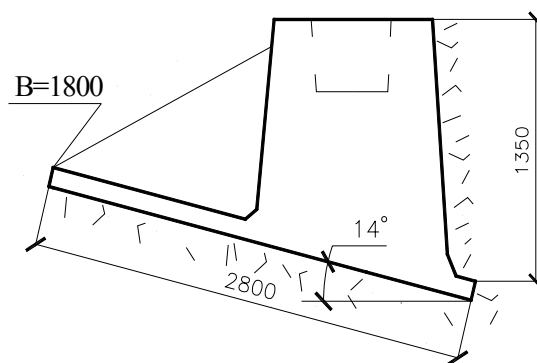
Блочний фунда­мент з розвинутою похилою підшоною
